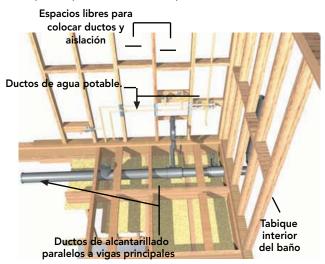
Colocación de ductos de alcantarillado y agua potable en los espacios que generan las estructuras de madera.
